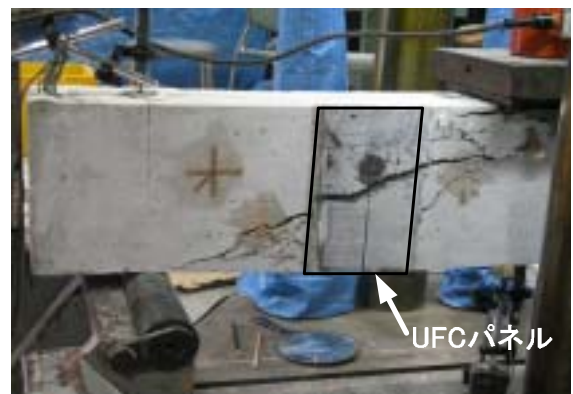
UFC パネル上に発生したひび割れ (A-type)
